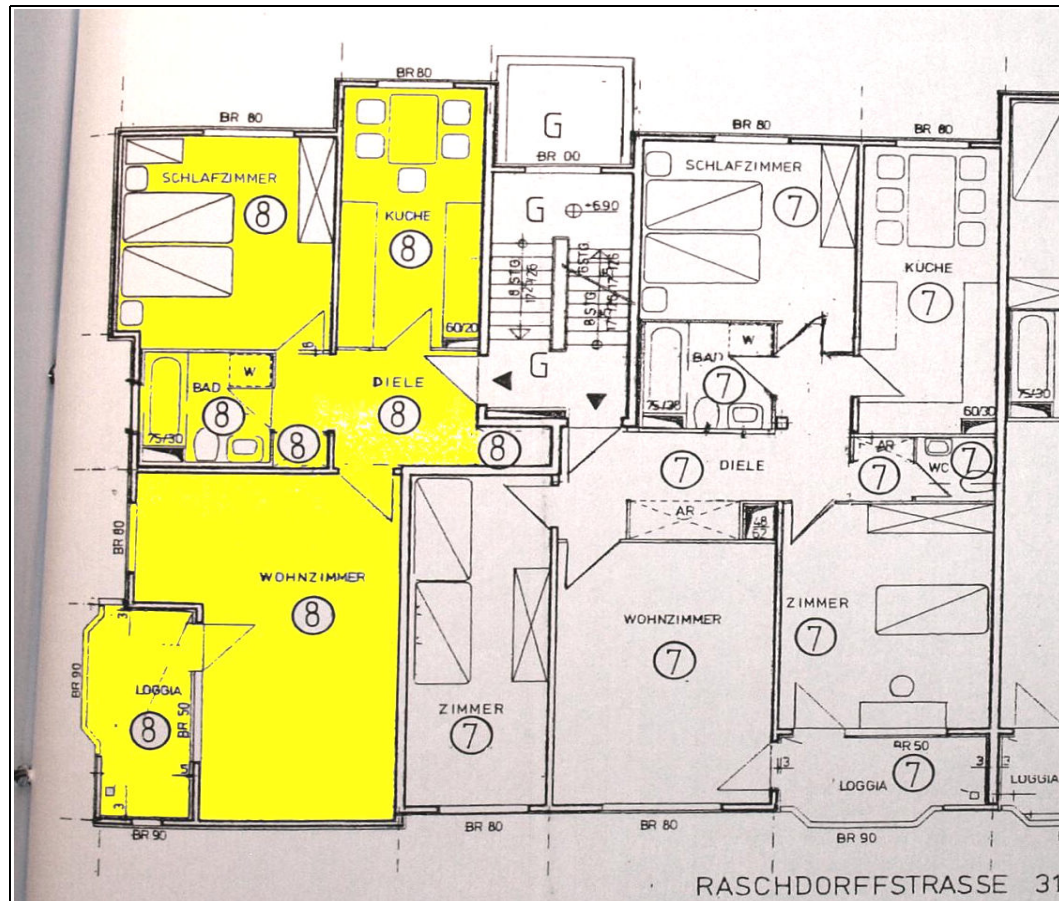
Grundriss des SE Nr. 8 im 3. OG
